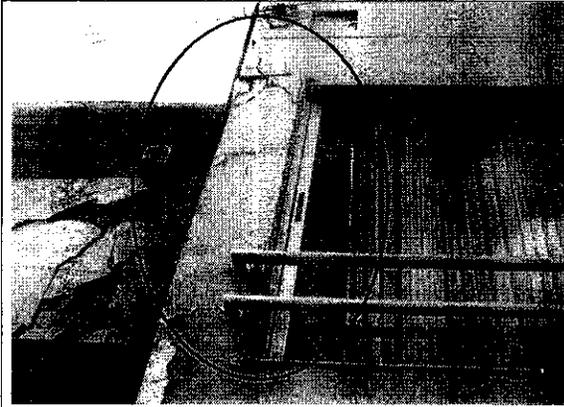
Agrietamientos en los muros de fachada correspondientes al apartamento 201.
